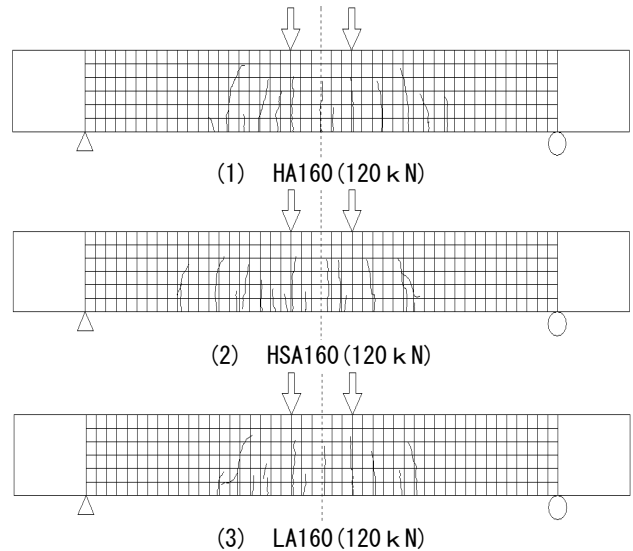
斜めひび割れ発生直前のひび割れ進展状況 160 シリーズ (載荷時の荷重)
